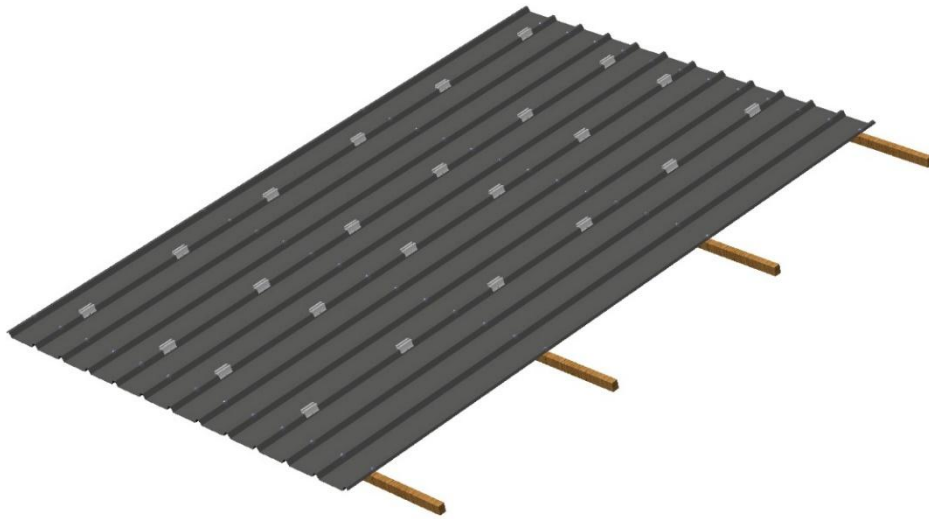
Vue d'ensemble des rails ISY-STEEL sur toiture en bac nervuré
